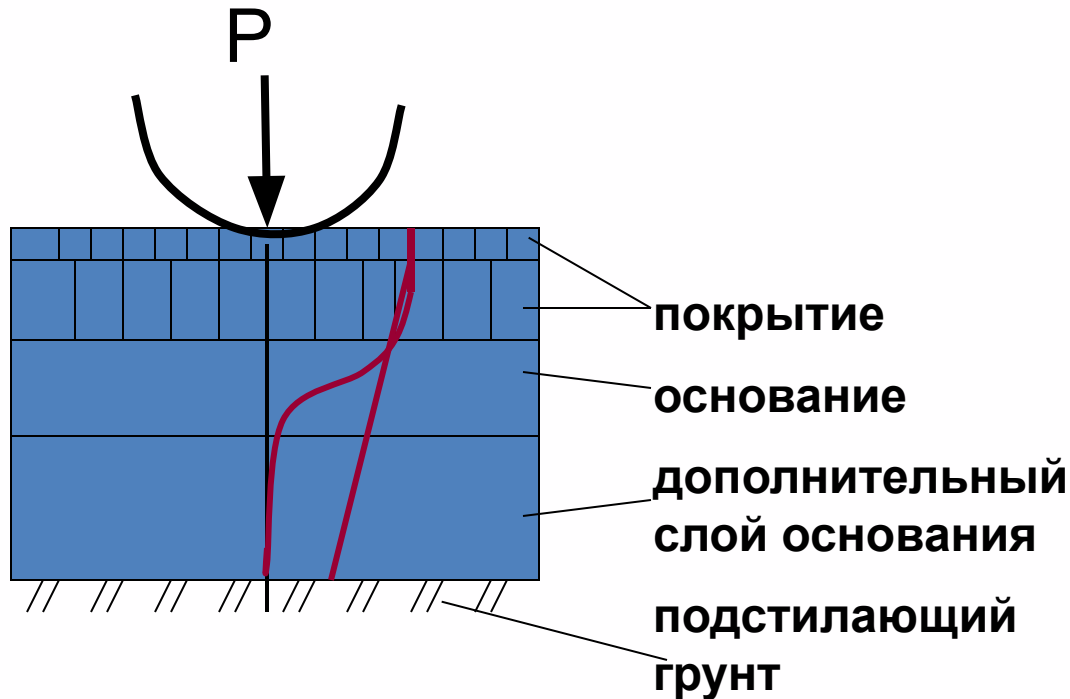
Конструкция железобетонного покрытия на Нюрнгринском угольном разрезе:
